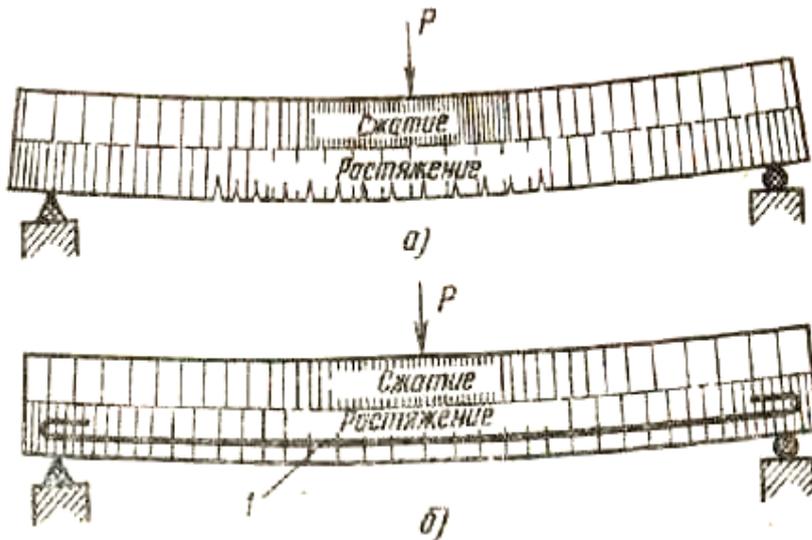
Неармована бетонна (а) і армована залізобетонна (б) балка; 1 - арматури
